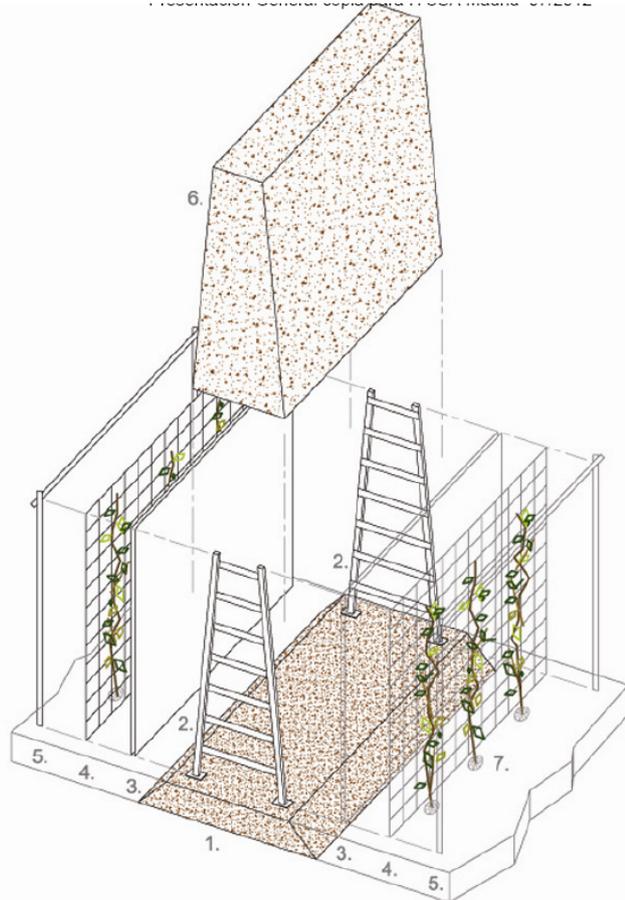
Sistema constructivo para la barrera acústica de tipo Arcbau Soluciones Ambientales.
